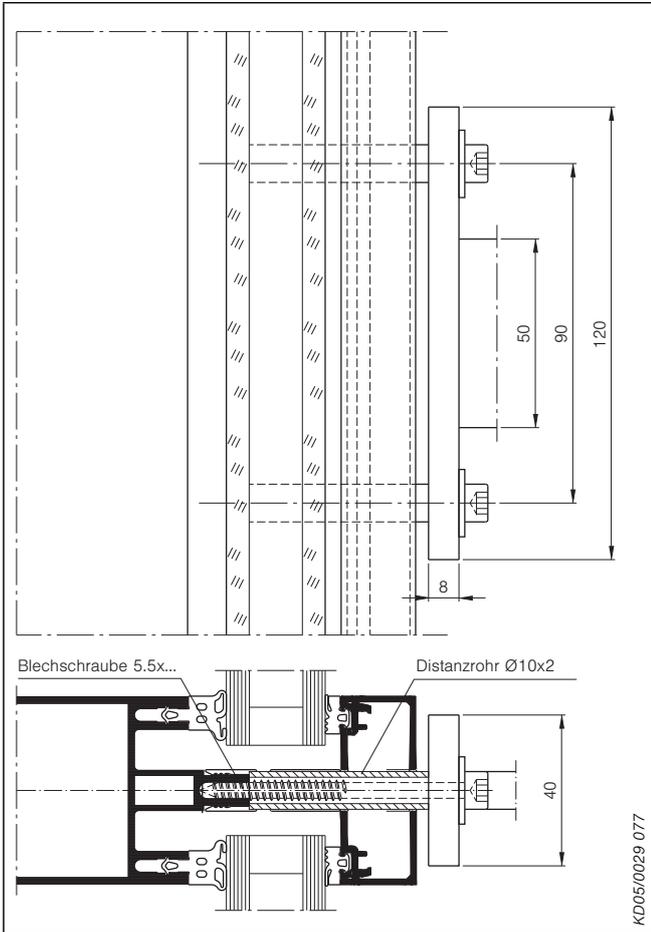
Befestigung des Führungsschienenhalters durch Distanzrohre zwischen Halter und Pfostenprofil
